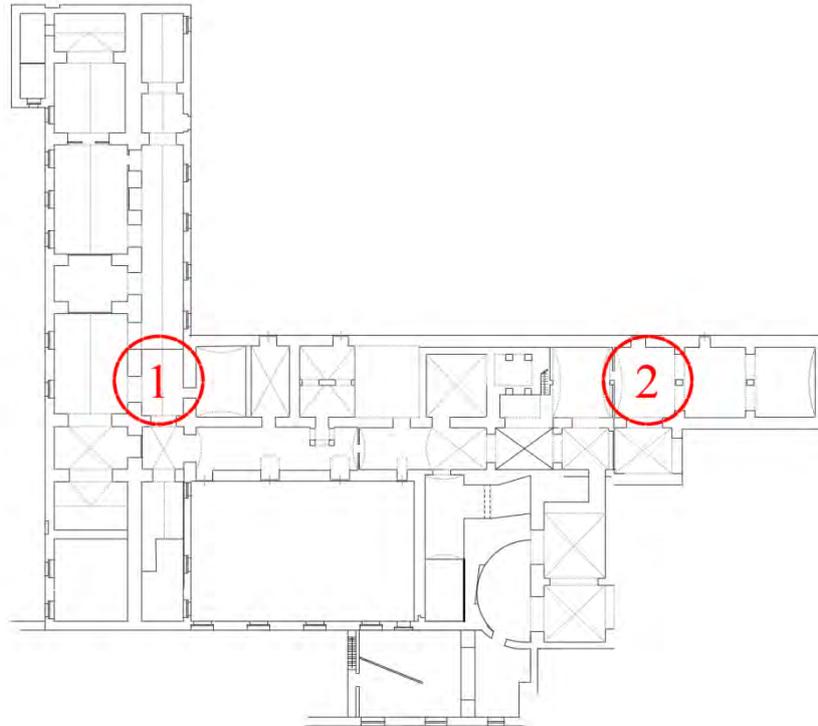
indicazione planimetrica delle volte rilevate in dettaglio: n.1 “Volta Calzaturificio”, n.2 “Volta con pilastro”
